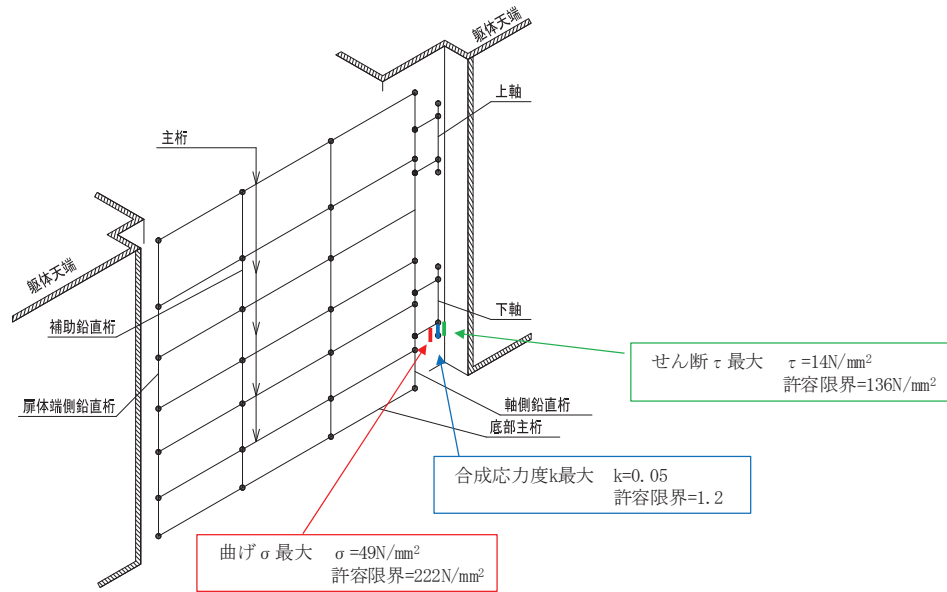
(3) ヒンジの曲げ・軸力系の破壊及びせん断破壊に対する
